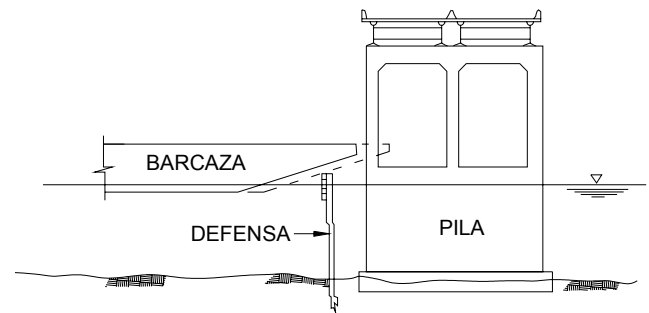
Vista en elevación de una saliente de la proa impactando contra una pila
